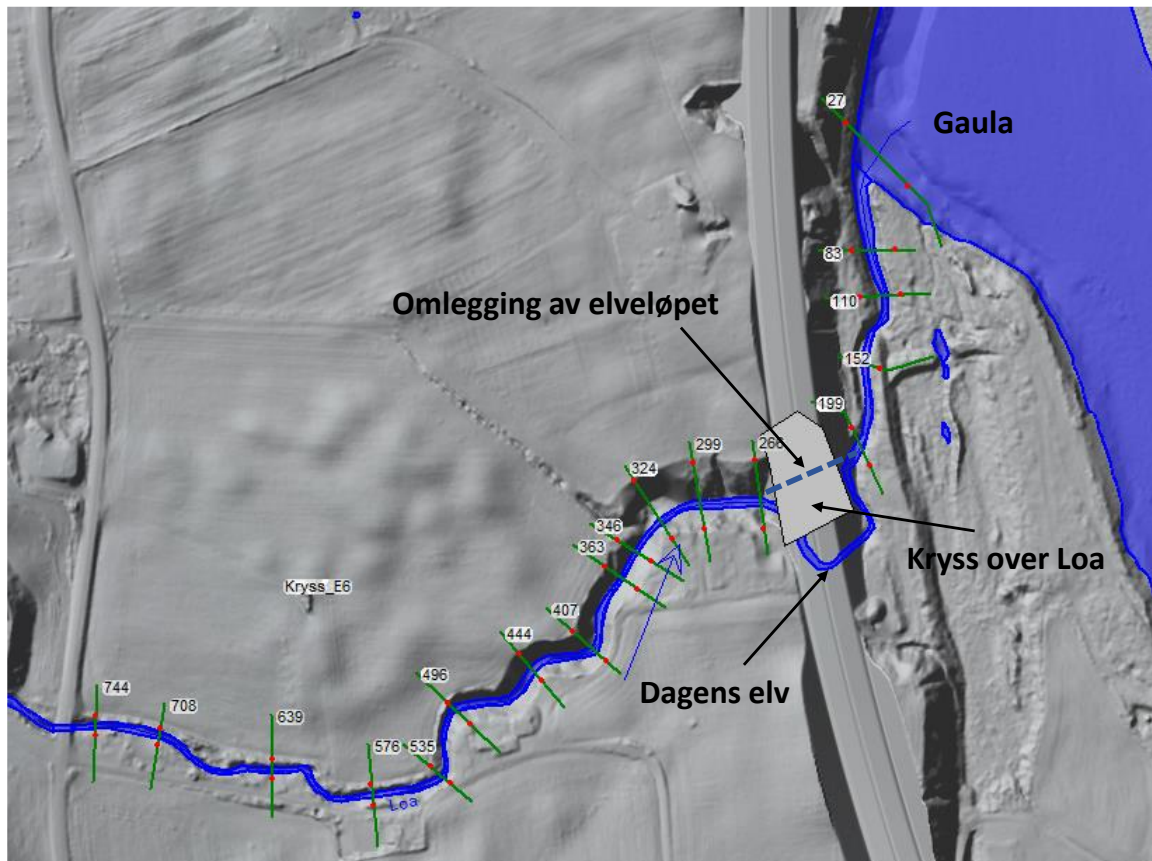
Planlagt brukryssing over Loa (Kilde: Norconsult)
